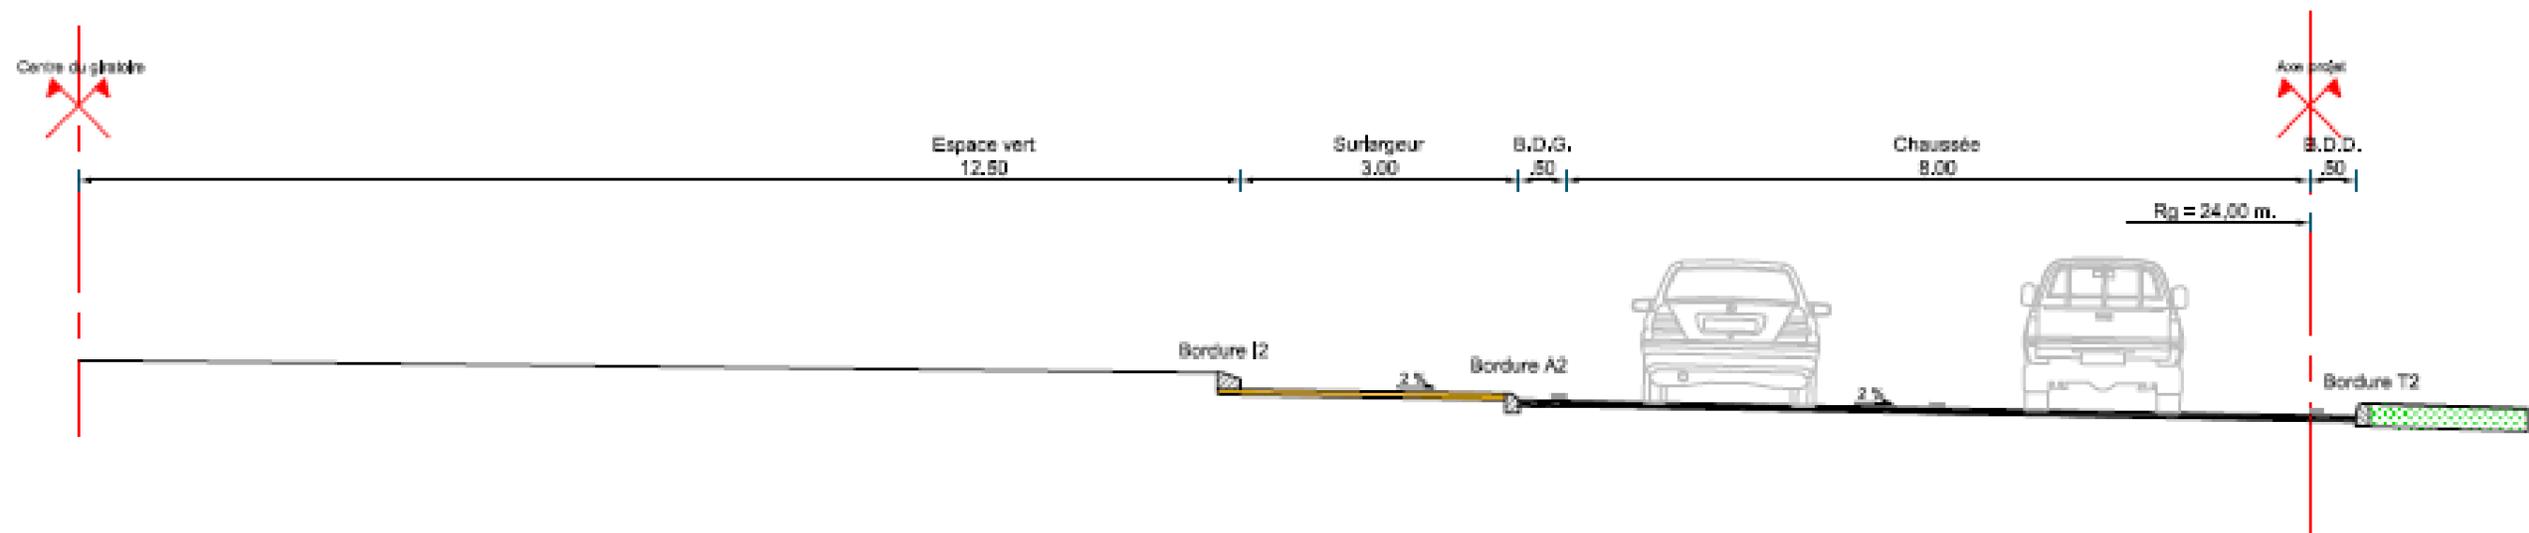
PROFIL EN TRAVERS TYPE DU GIRATOIRE EST SUR LA RT11
